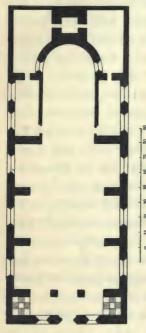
Innsbruck. Kollegs= tirche von 1619. Grundriß. (Nach Originalgrundriß.)
